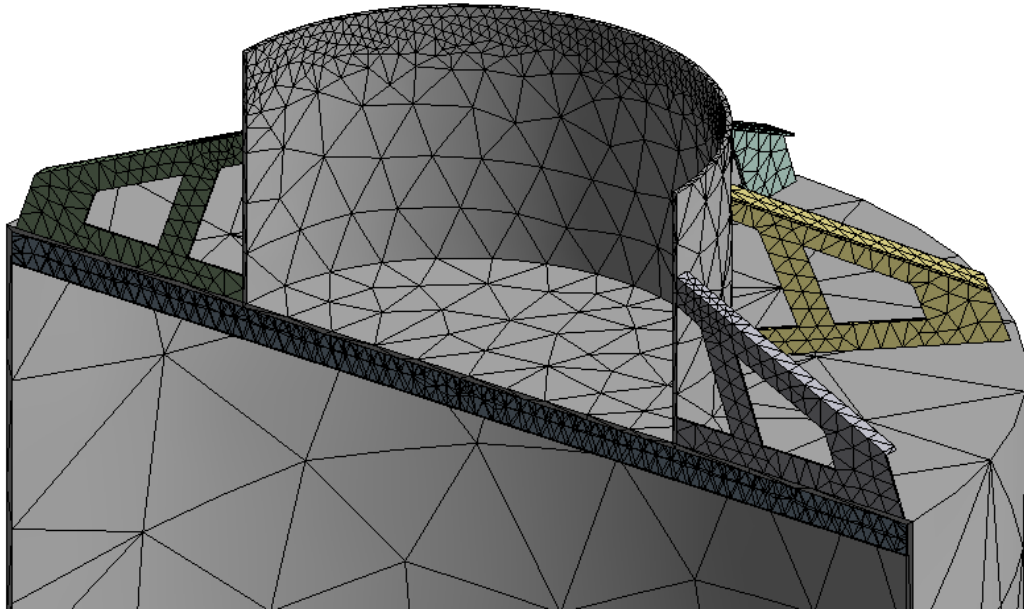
Malha do modelo estrutural da fundação. Fonte: Elaborado pela autora.
